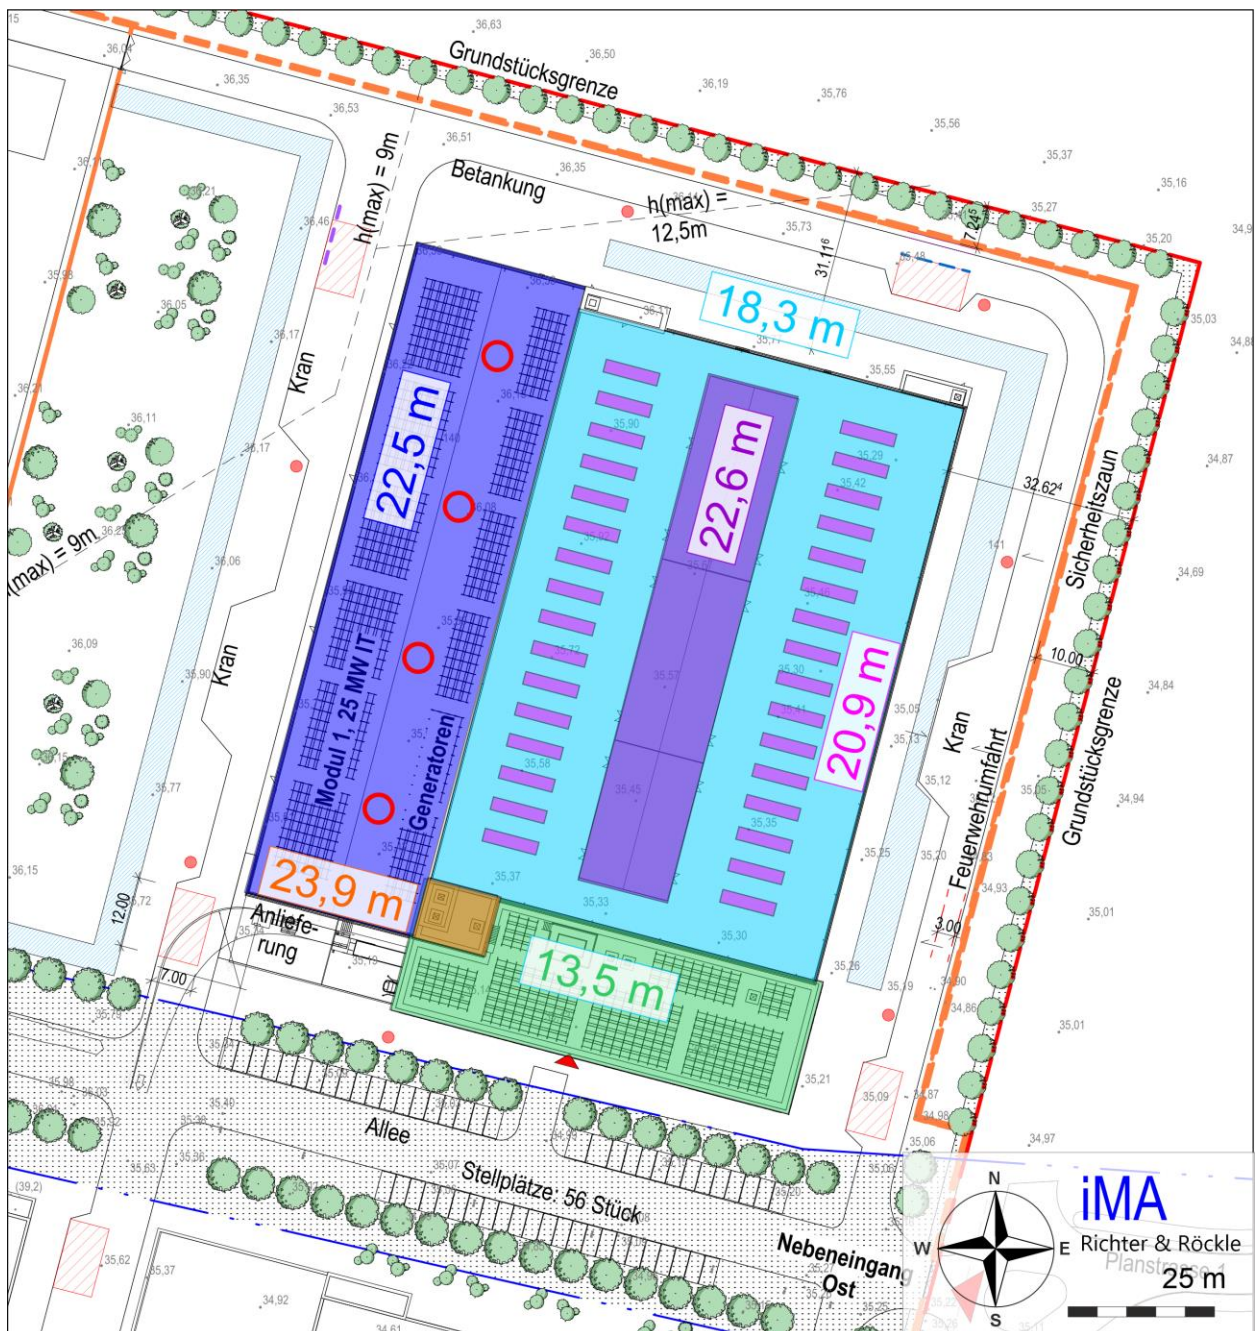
Gebäudehöhe von Modul M5 und Lage der Netzersatzanlagen sowie der Schornsteingruppen (rote Kreise). (Kartengrundlage: Lageplan Masterplan, TTSP-HWP, THP-00-AC-2-00-SP-GX-1100.pdf, Stand 29.02.2024).
